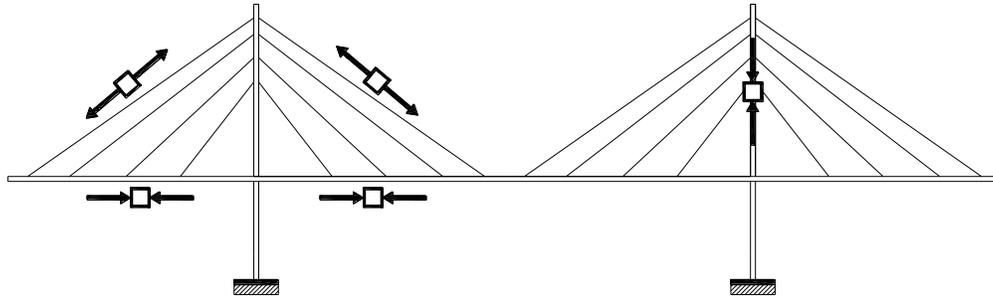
Esfuerzos actuantes en un puente atirantado.
